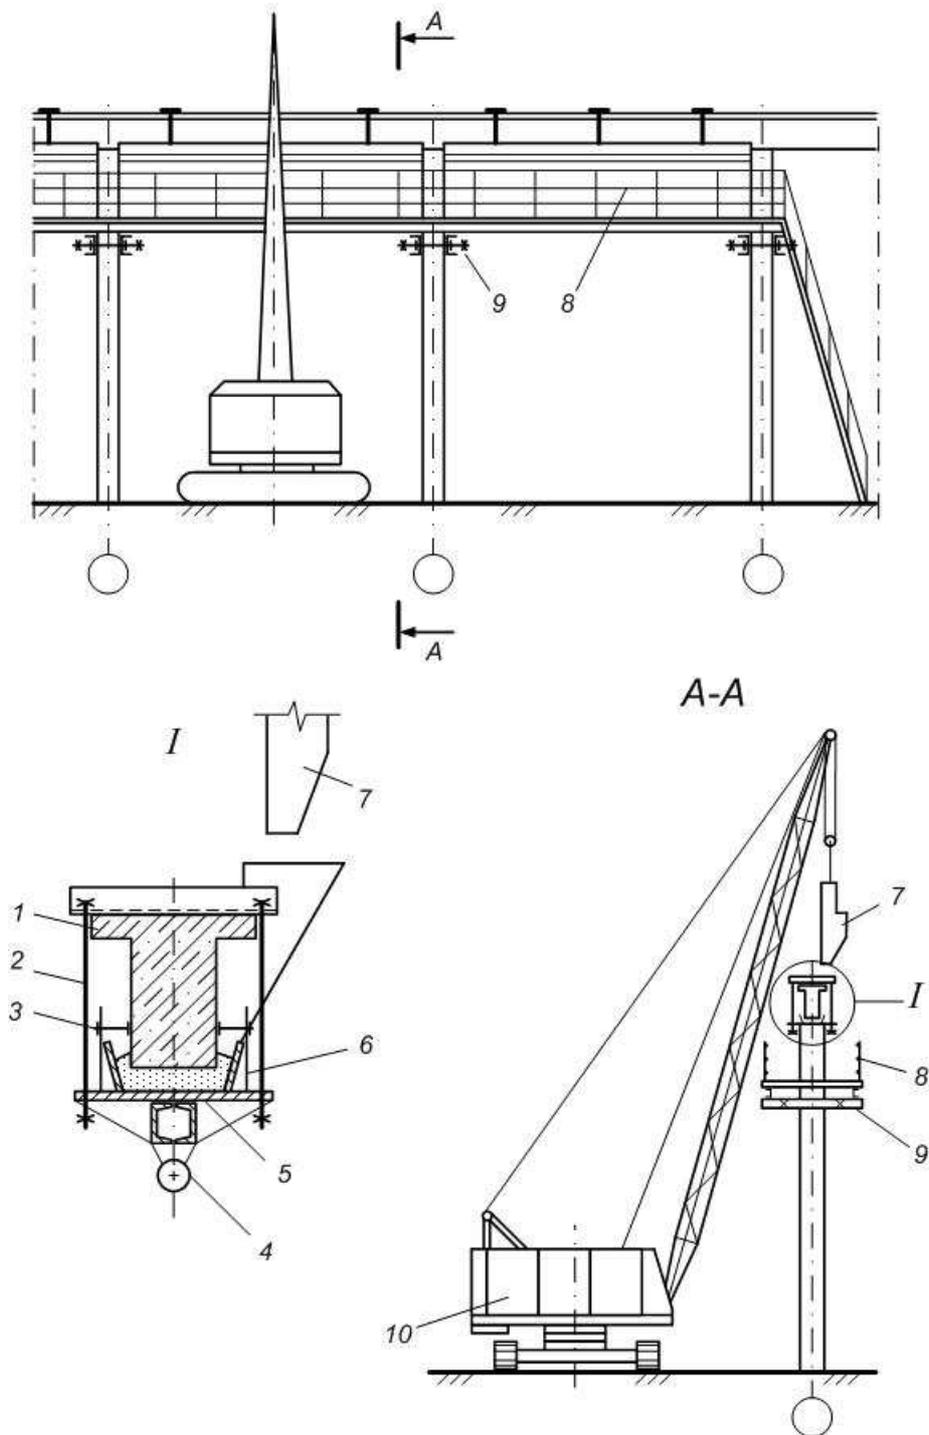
Усиление подкрановой балки с креплением рабочих площадок на металлических консолях: 1 – усиливаемая балка; 2 – подвеска; 3 – прижимной винт; 4 – вибратор; 5 – блок-форма; 6 – бетон усиления; 7 – бадья для бетона; 8 – рабочая площадка с ограждением; 9 – металлическая консоль; 10 – монтажный кран
